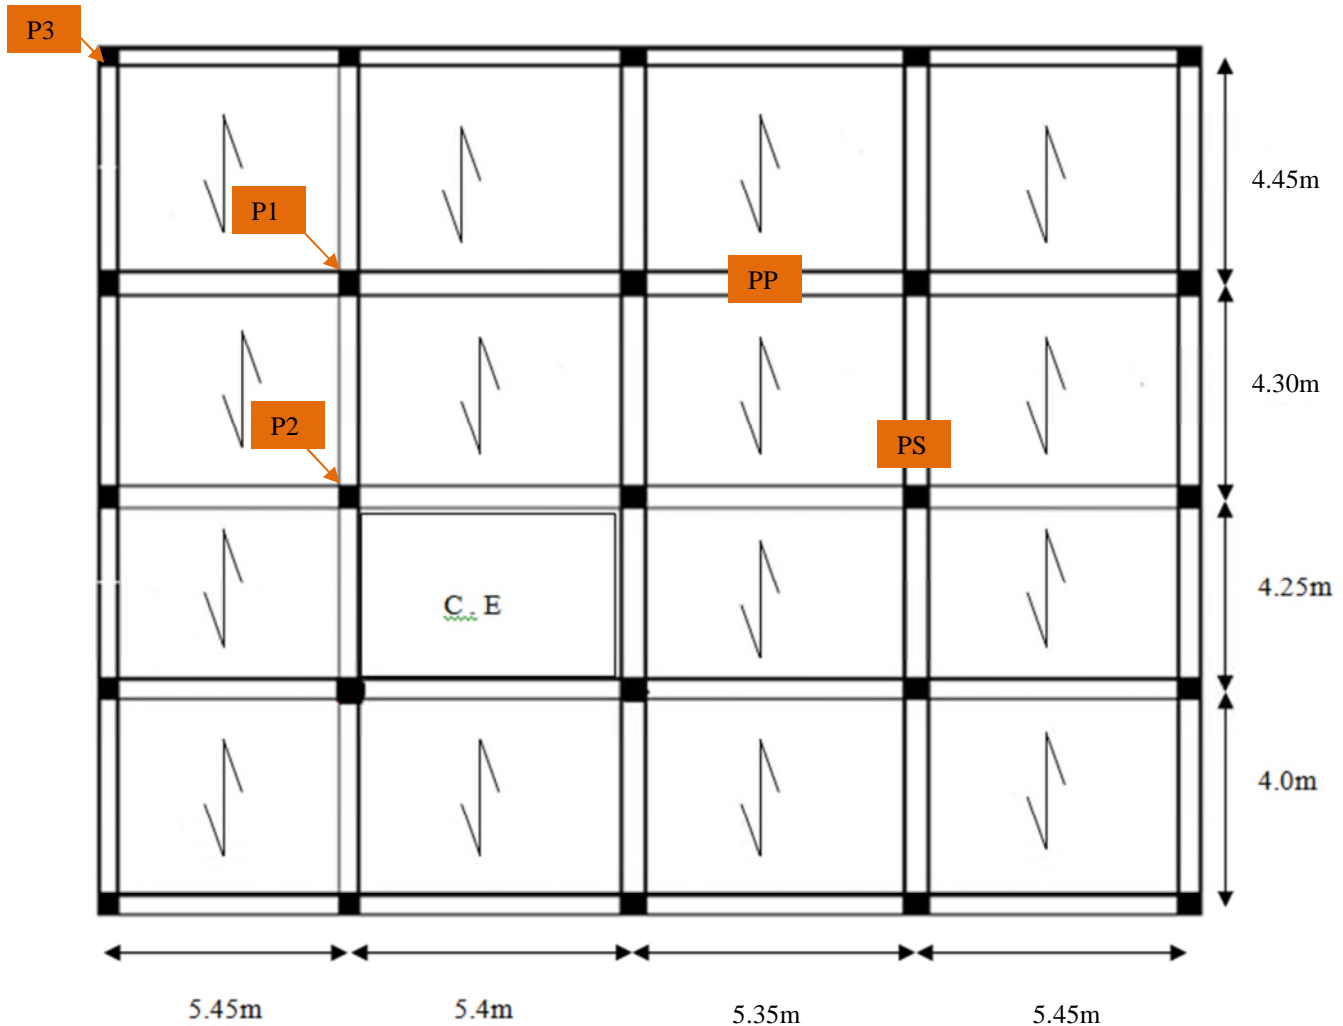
Disposition des poutrelles dans le plancher commerce (sous-sol).
